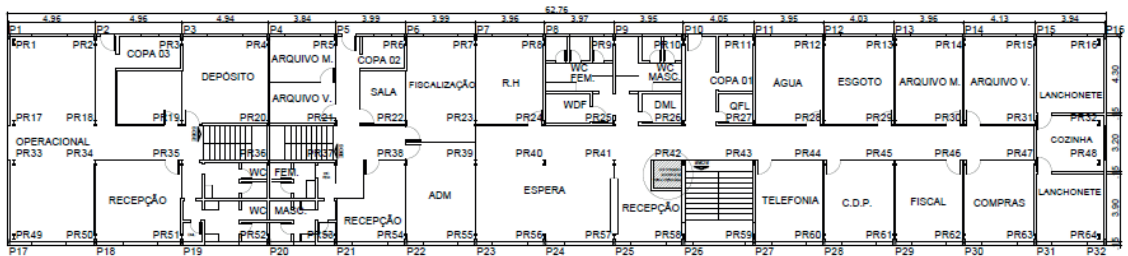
Pavimento térreo: distribuição dos pilares de concreto existentes (P) e dos pilares metálicos de reforço.
